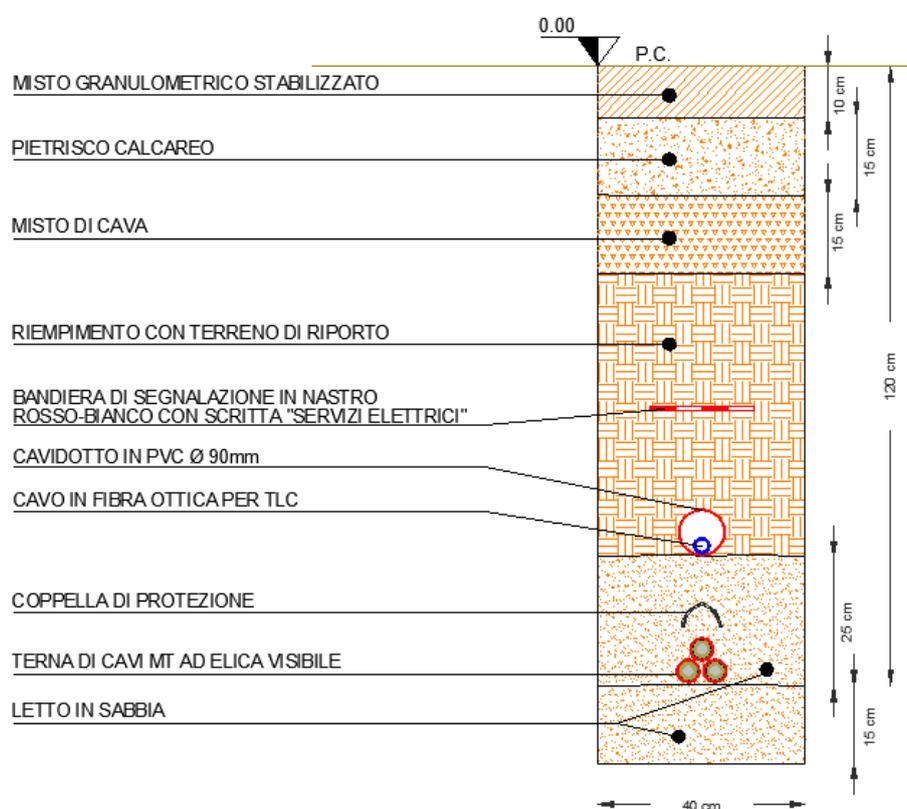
Sezione tipo di scavo per la posa del cavidotto su strada esistente
